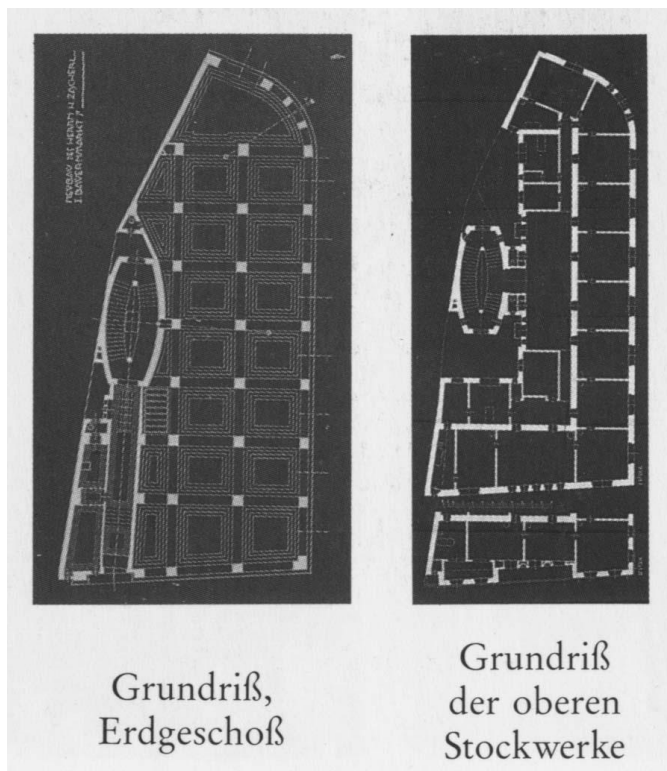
Zacherl-Haus, Grundrisse
